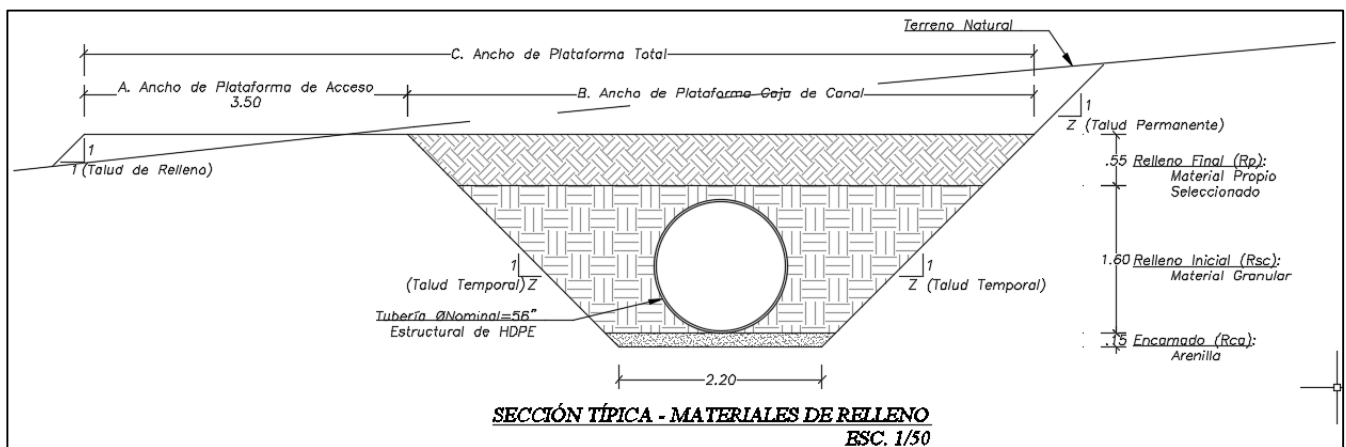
Sección típica del canal de conducción Vilachauhani. De Proyecto Especial Tacna.
